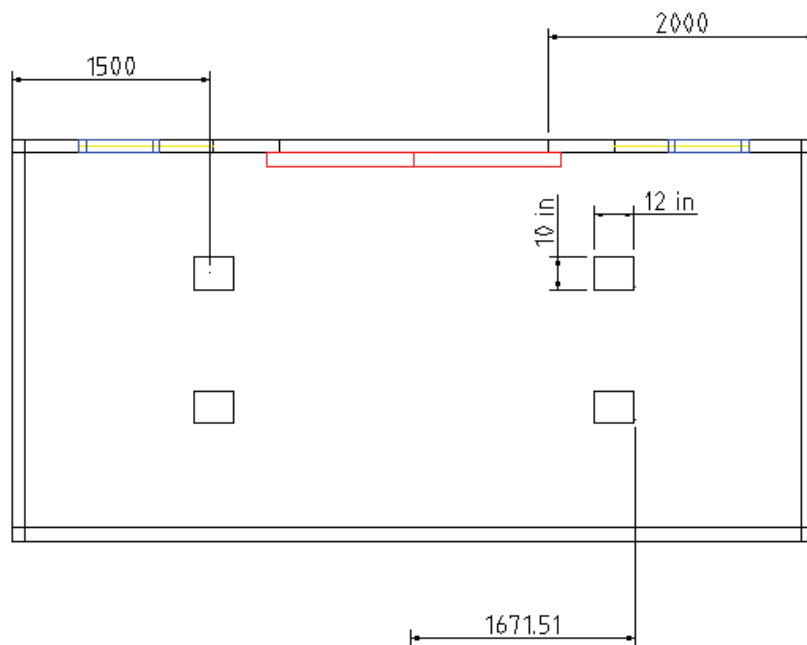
Vista superior del sistema de encapsulamiento de la cabina de molinos
